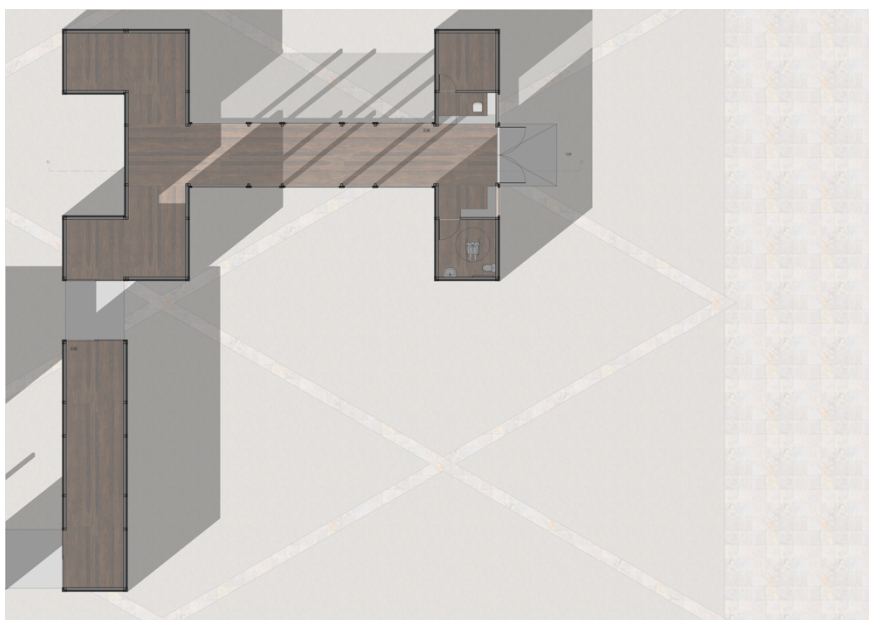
Planta de pormenor dos dois primeiros agregados do conjunto arquitetónico.
